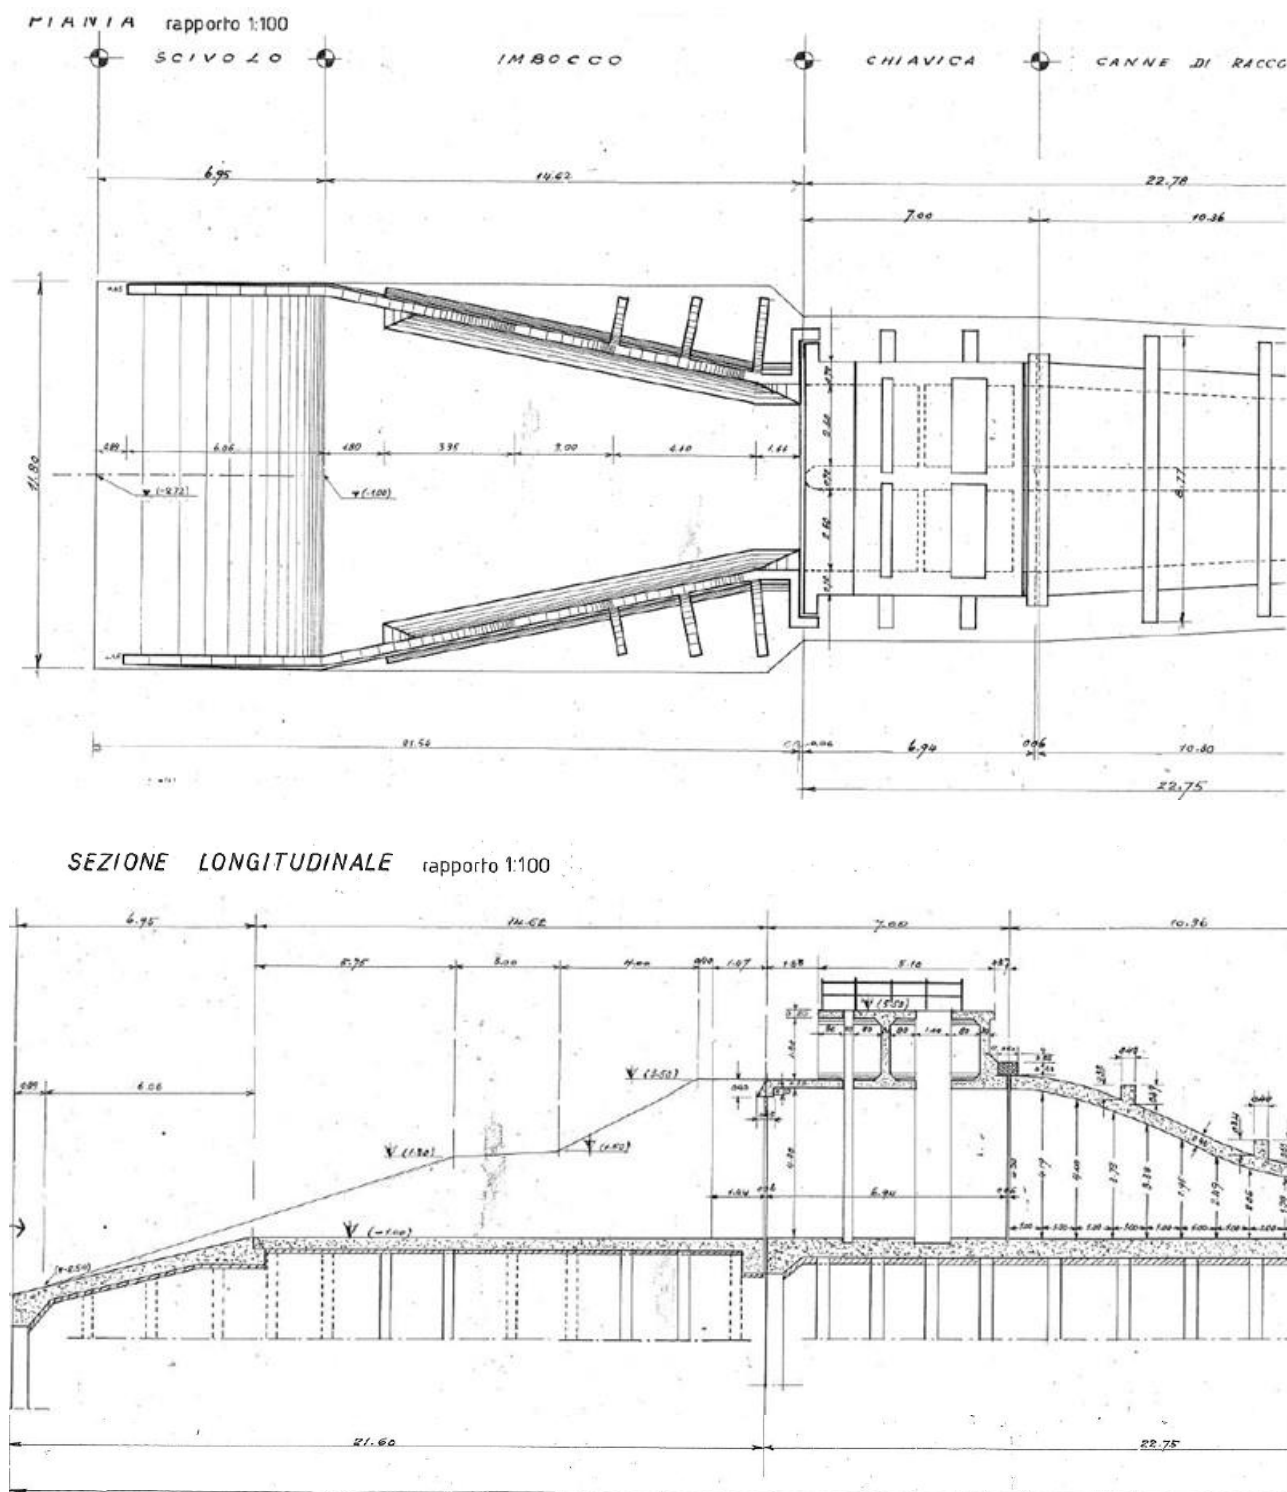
Pianta e profilo della Chiavica di derivazione da Reno (Fonte: tavole di progetto fornite da CER)
